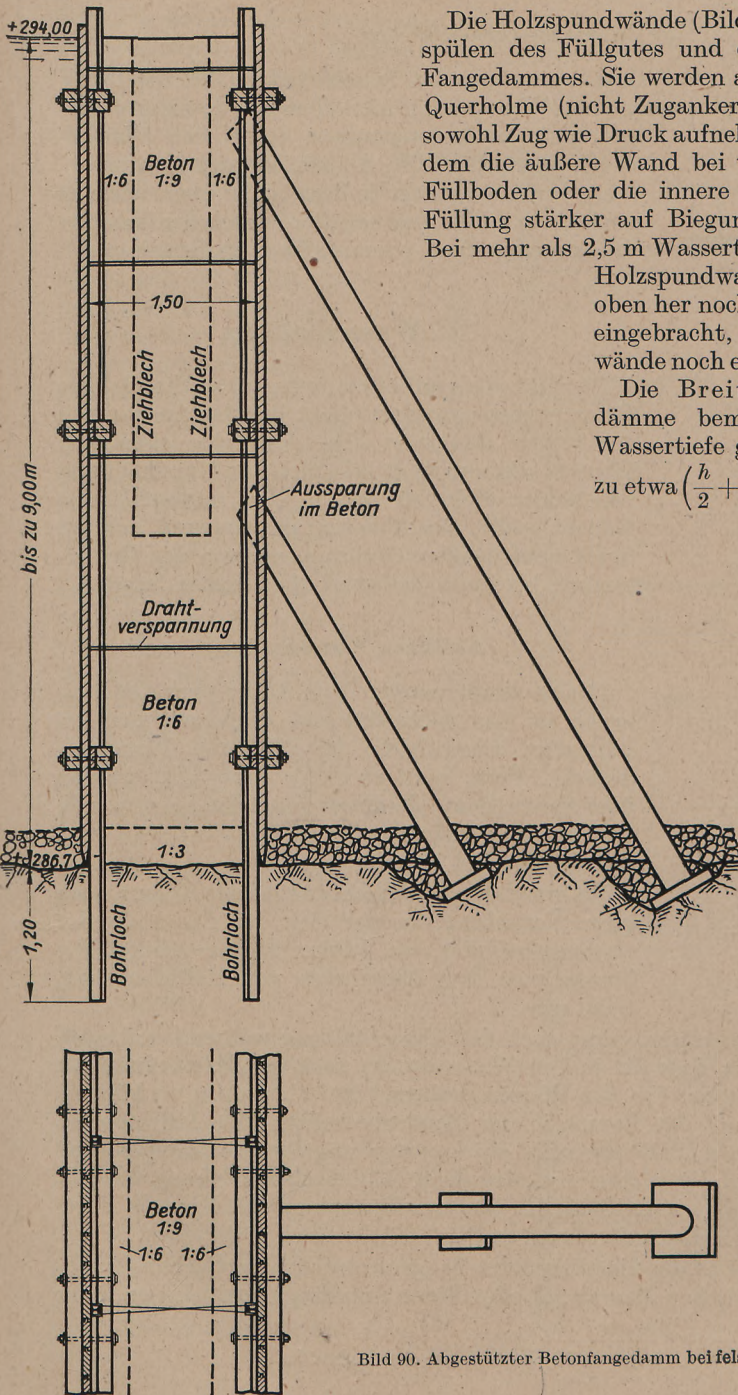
Abgestützter Betonfangedamm bei felsigem Untergrund
